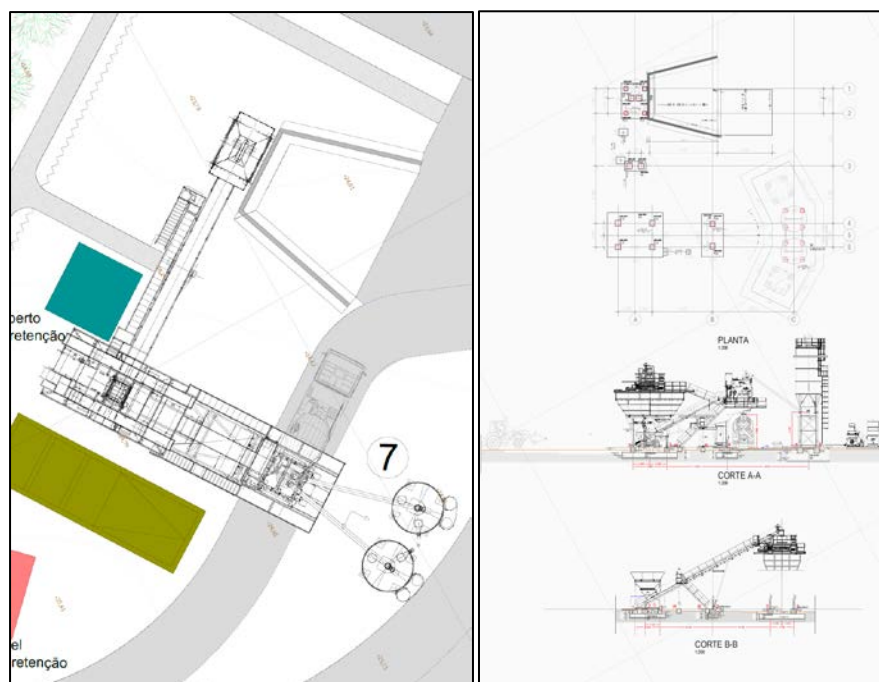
Implantação da central de betão (Fonte: Dar, 2025)
